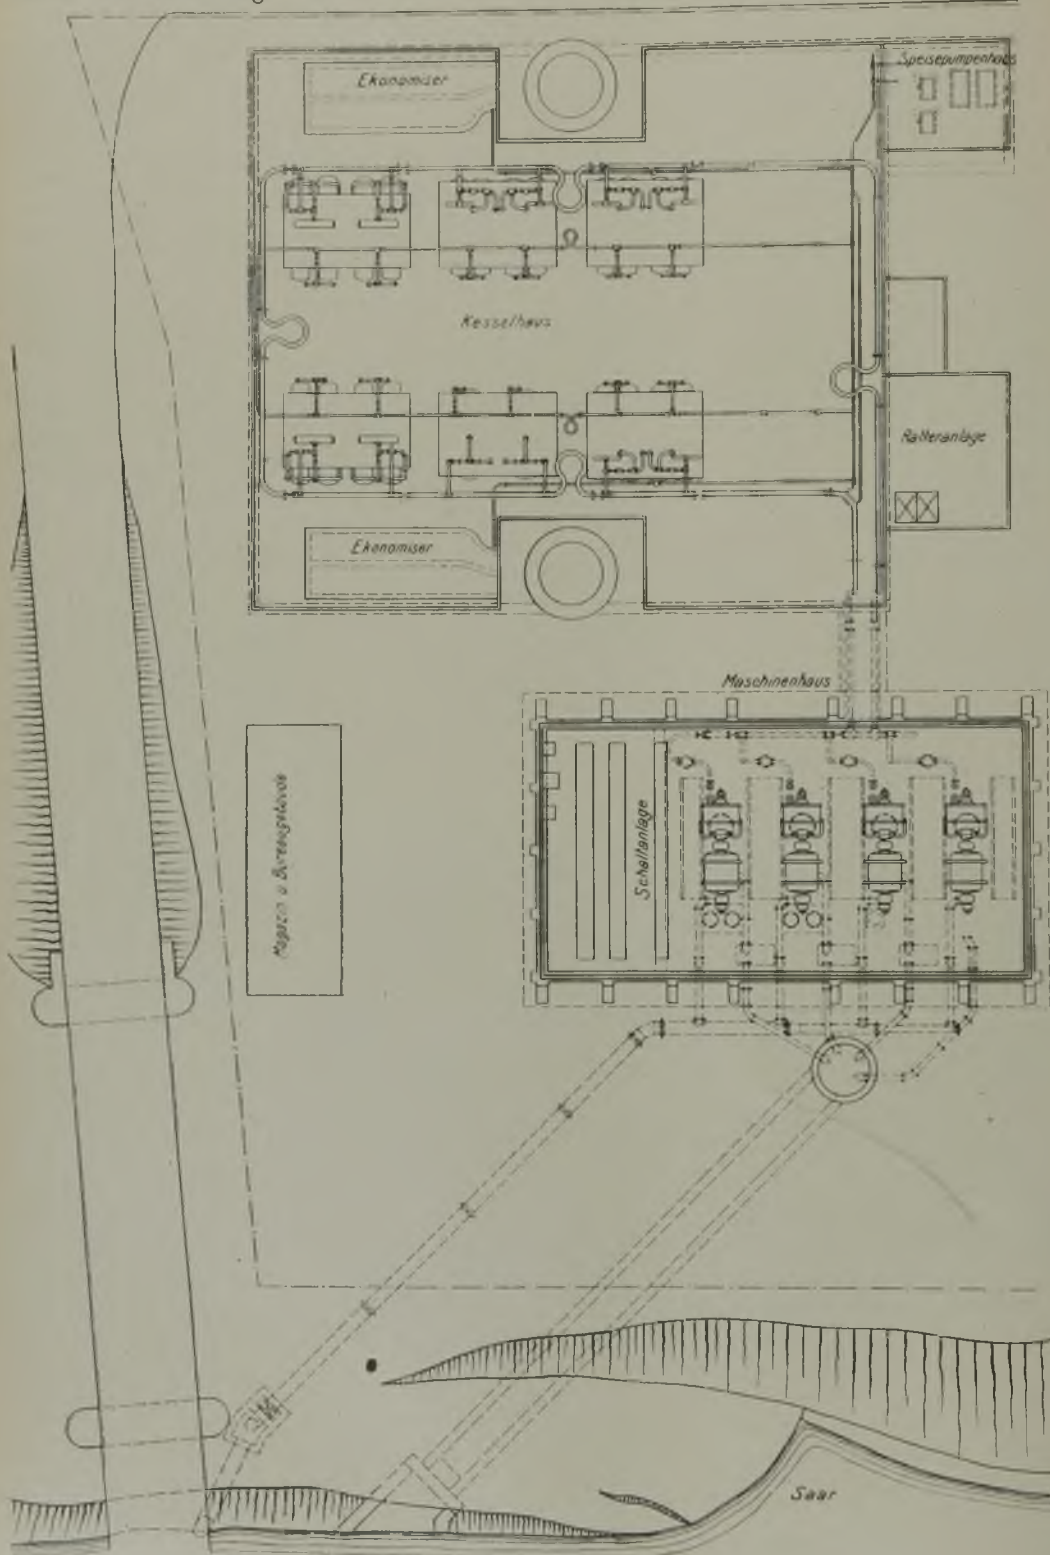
Grundriß der elektrischen Zentrale Louisenthal.
